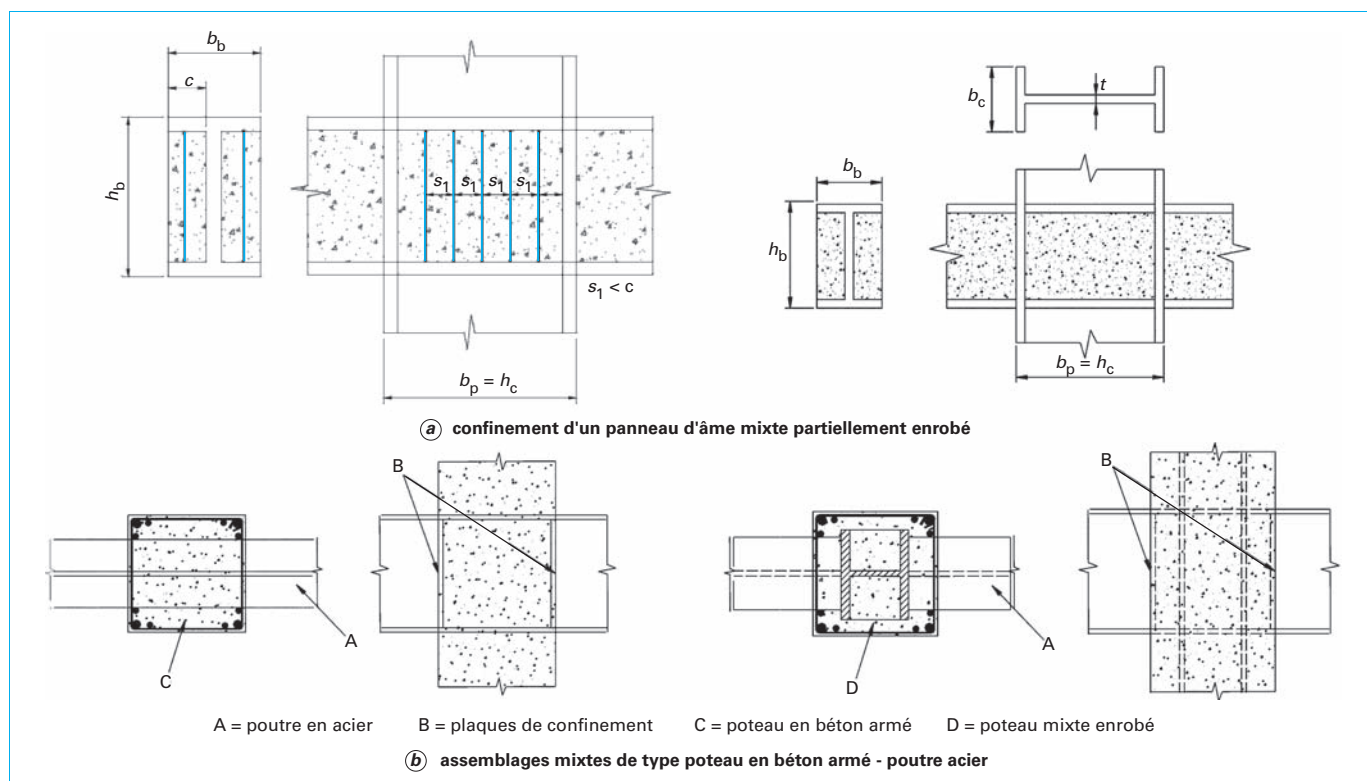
Confinement d'un panneau d'âme mixte partiellement enrobé et assemblages mixtes de type poteau en béton armé/poutre acier
